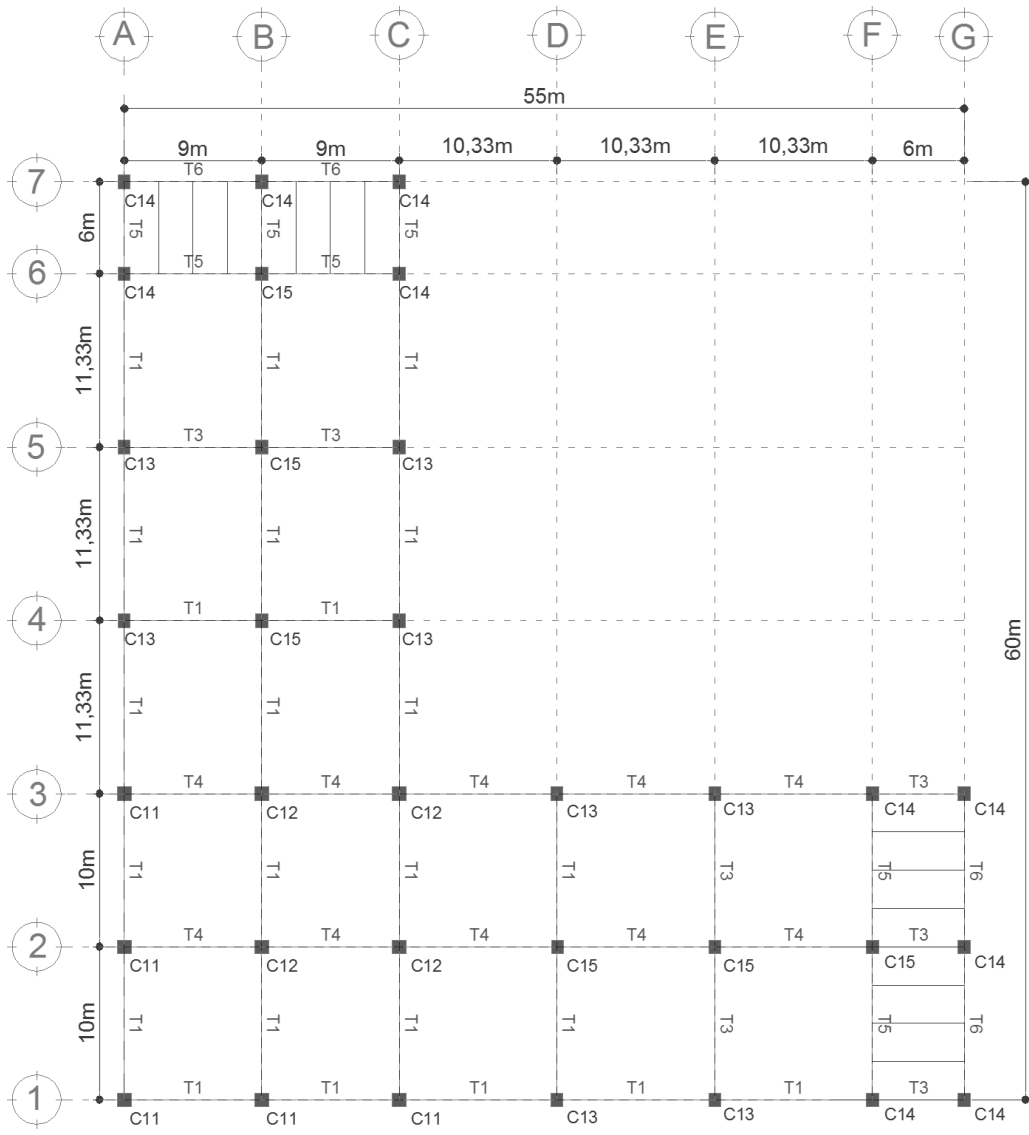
Distribución de columnas y traves en los niveles 5, 6 y 7.
